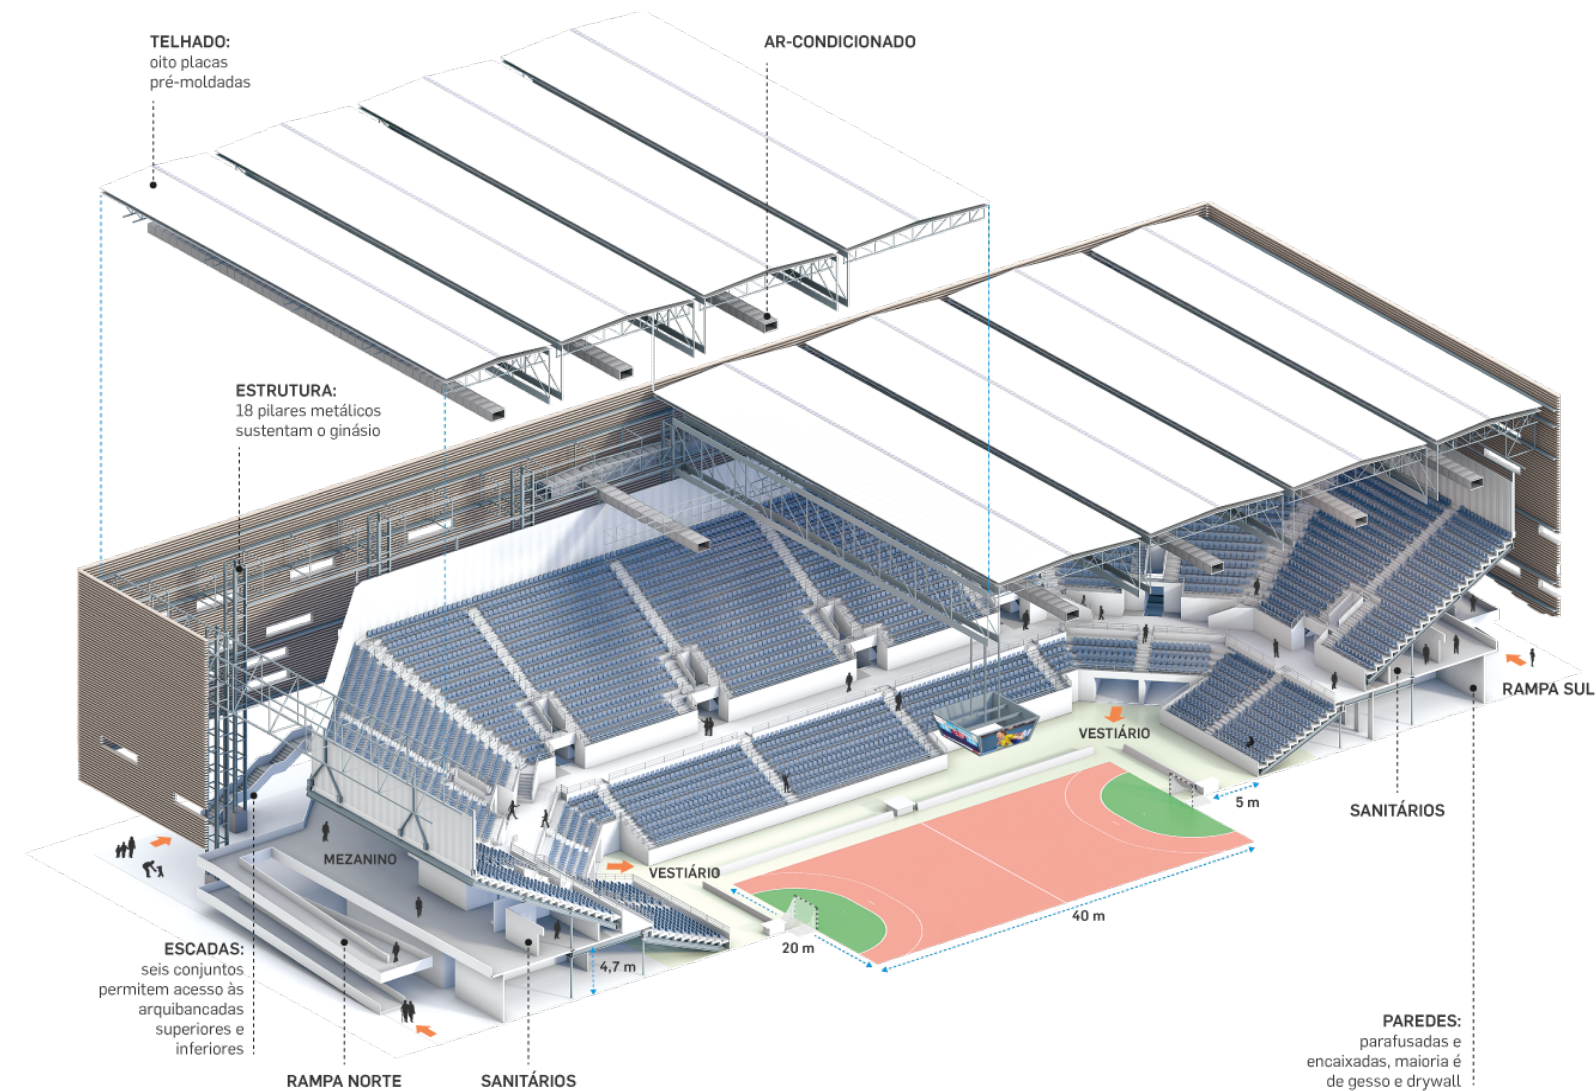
, 33 e 34: Arena Futuro. Representação da base confeccionada em concreto, divisória de gesso e drywall e armações metálicas. Olimpíadas Rio 2016.
